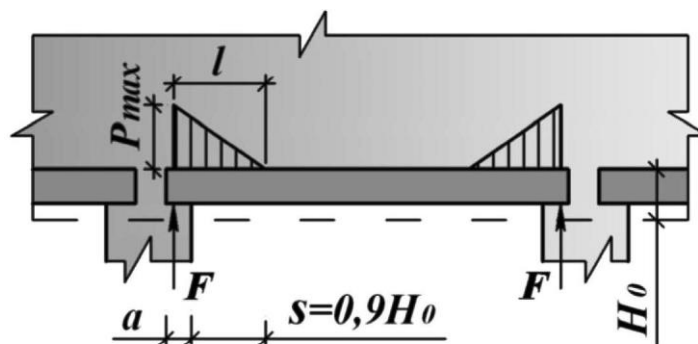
Схема для визначення навантаження, що діє на фундаментну балку при затверділому розчині [6]
